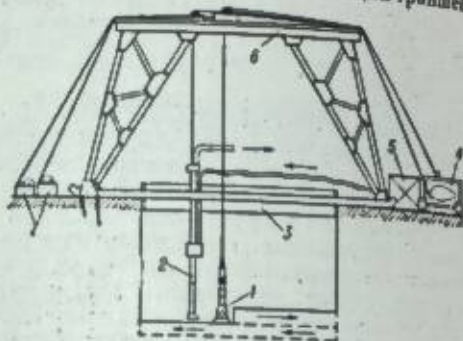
Схема разработки траншеи буровой установкой: 1 — долото; 2 — эрлифт; 3 — кондуктор; 4 — ударно-накатный станок; 5 — компрессор; 6 — передвижной копер; 7 — лебедки.
